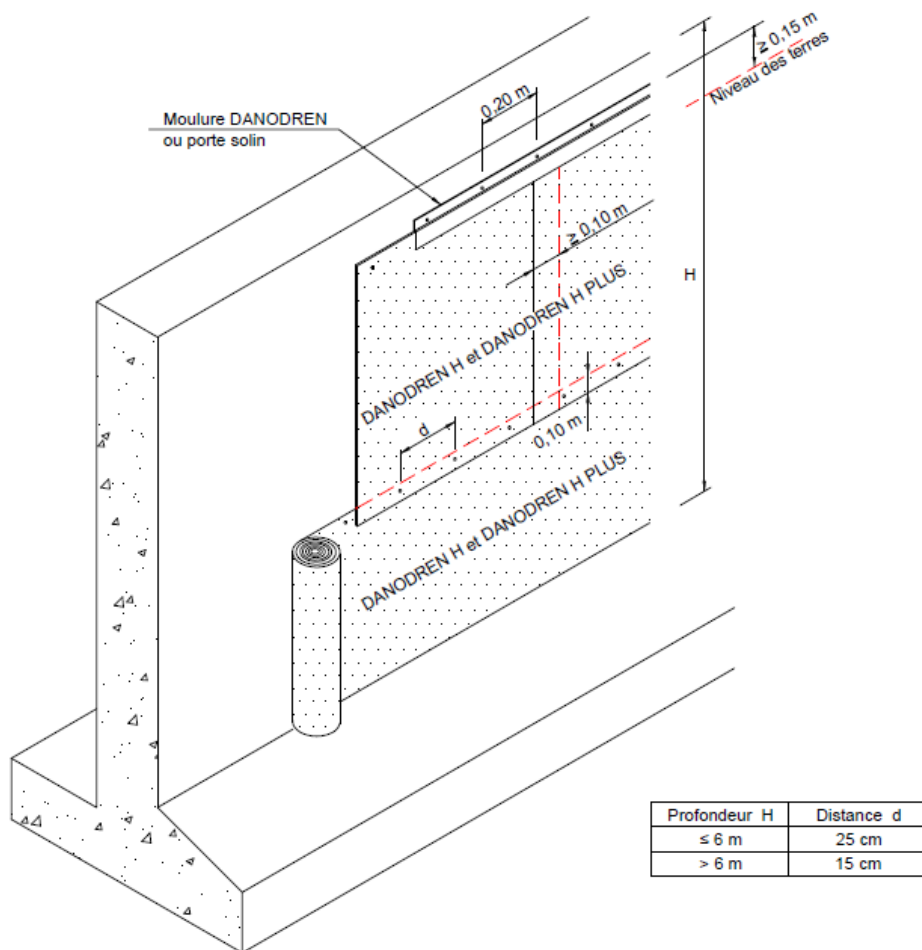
ter - Schéma de principe sans revêtement d'étanchéité (sens de pose horizontal)
